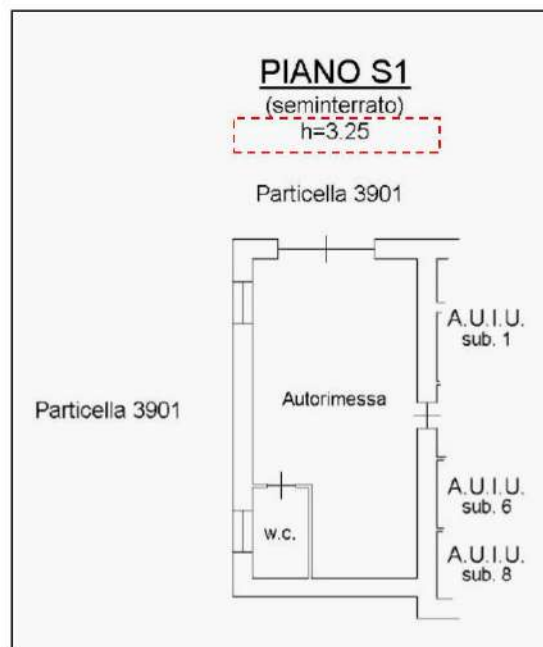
Planimetria castale Autorimessa (Sub. 2)
